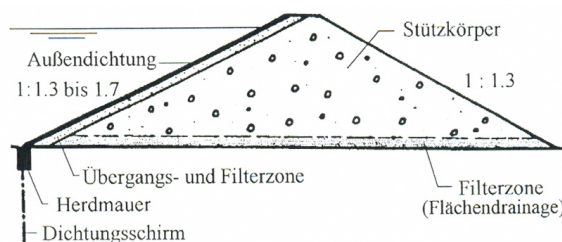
prinzipieller Aufbau, Damm mit Oberflächendichtung aus: [8]
